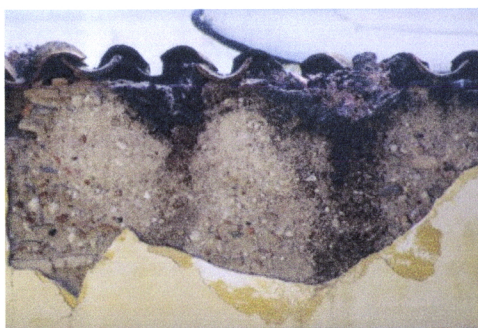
Moura, Bairro da Mouraria, uso da taipa no edificado (foto da autora)
